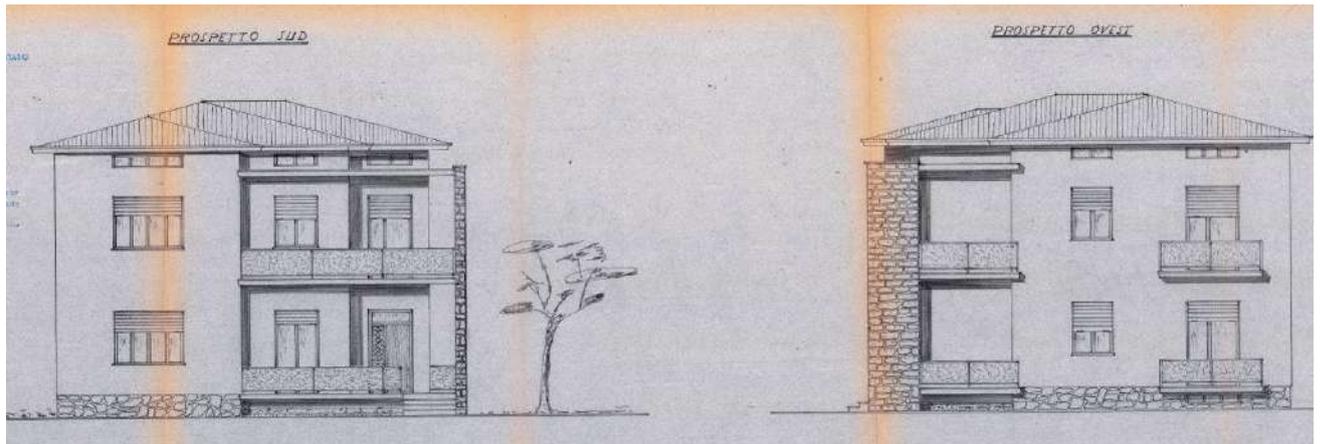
Licenza di Costruzione n. 1289 del 04.03.1968 – prospetti
